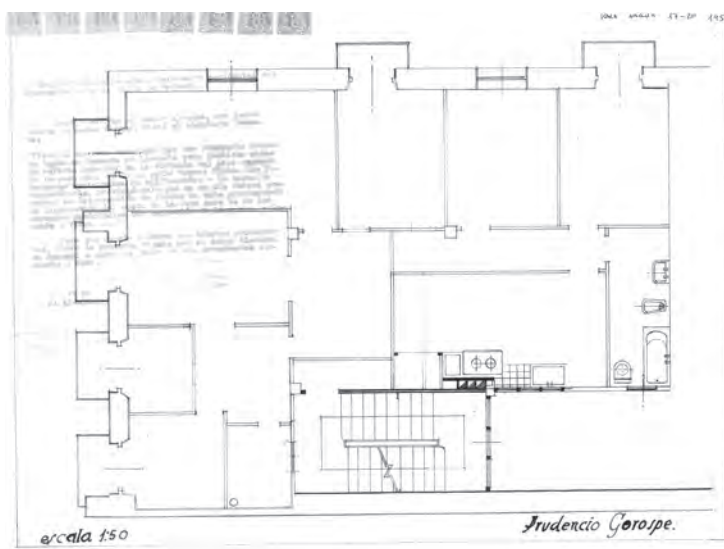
25. 1958. PLANO DE LA VIVIENDA DE LA 2ª PLANTA
